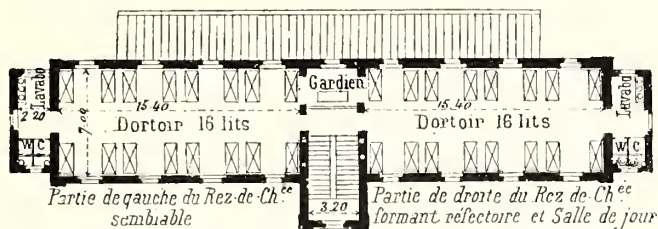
Pavillon des Epidémies - Plan du Rez-de-Chaussée
